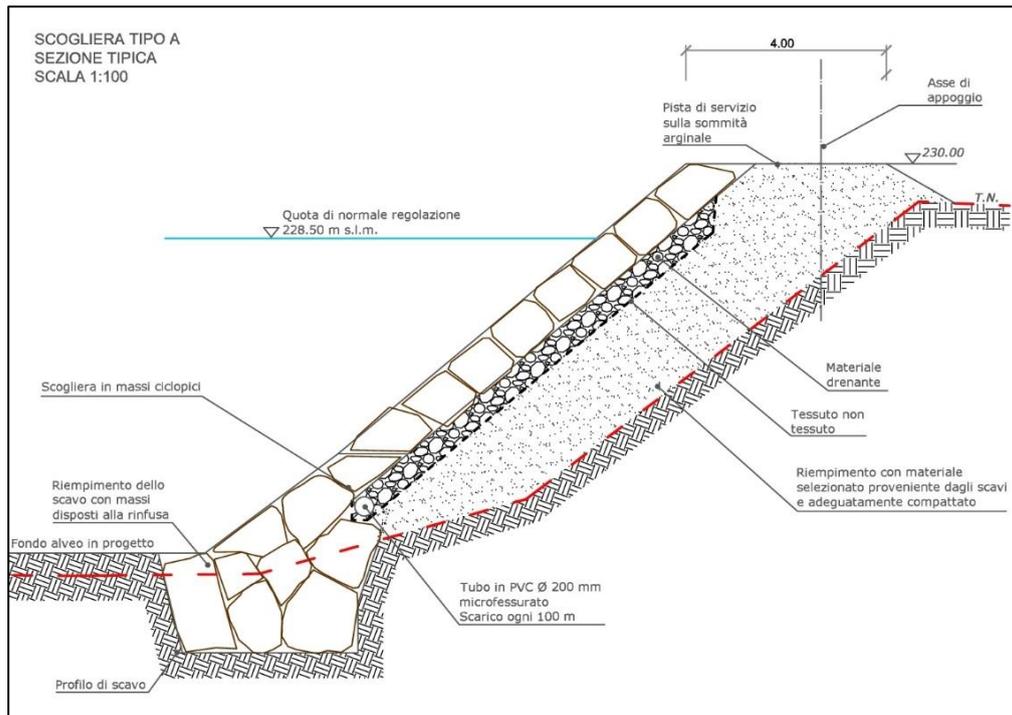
SEZIONE TIPO DELLE DIFESE SPONDALE DI NUOVA COSTRUZIONE CON STRADA ALZAIA – STRALCIO TAVOLA IVR027
